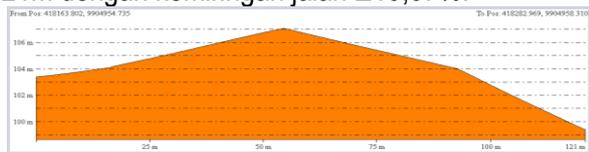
Penampang Kemiringan Jalan Tambang Pit 3E Segmen 1-2
